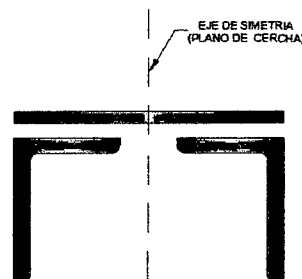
68: Simetría de perfiles según el plano de la cercha.
